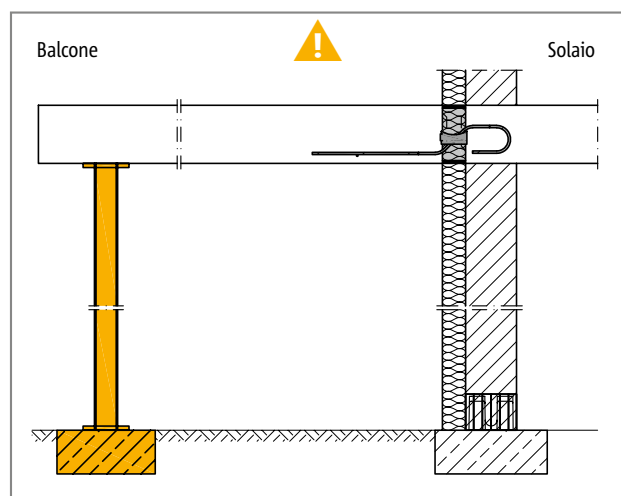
Schöck Isokorb® T tipo QL: è necessario un appoggio continuo
